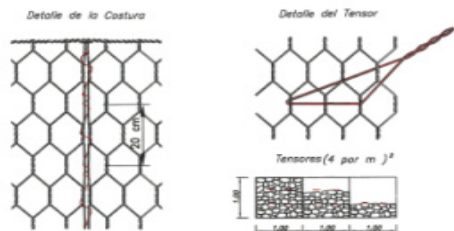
Detalle de amarre y de los tirantes. (Cortesía de Gaviones Bekaert).
